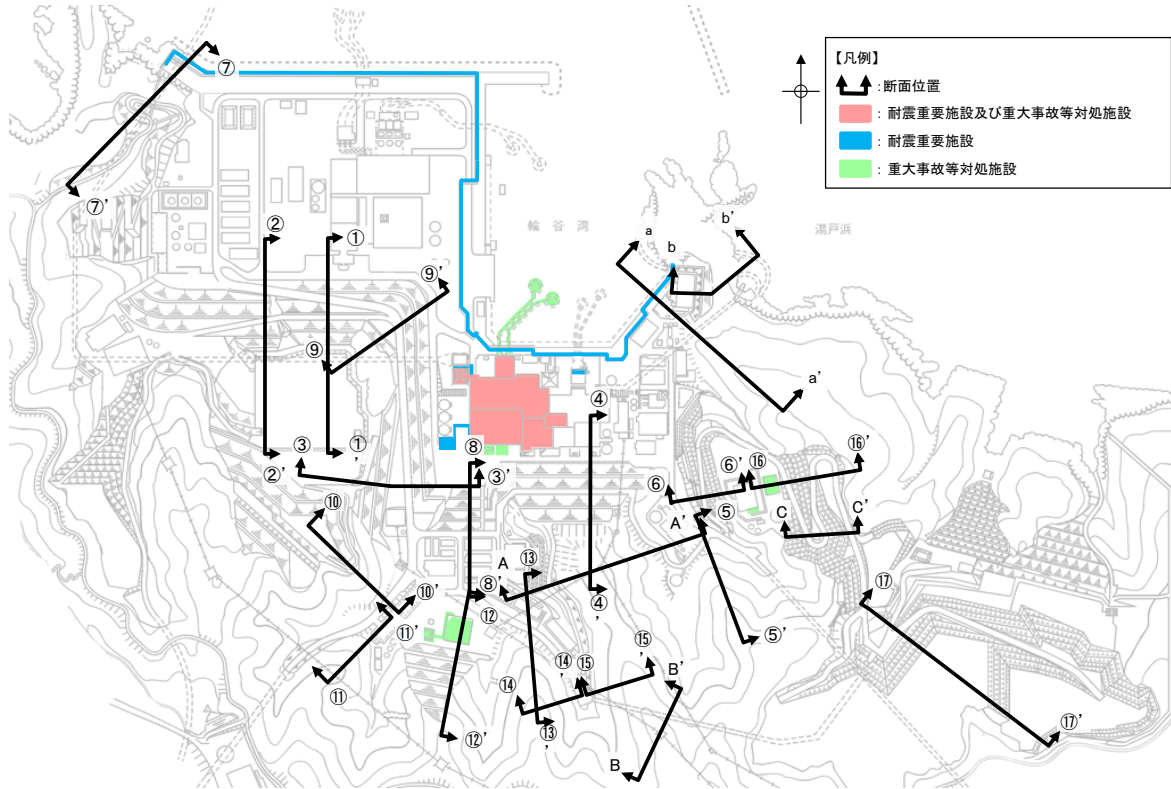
保管場所等に影響するおそれのある斜面の平面位置図
